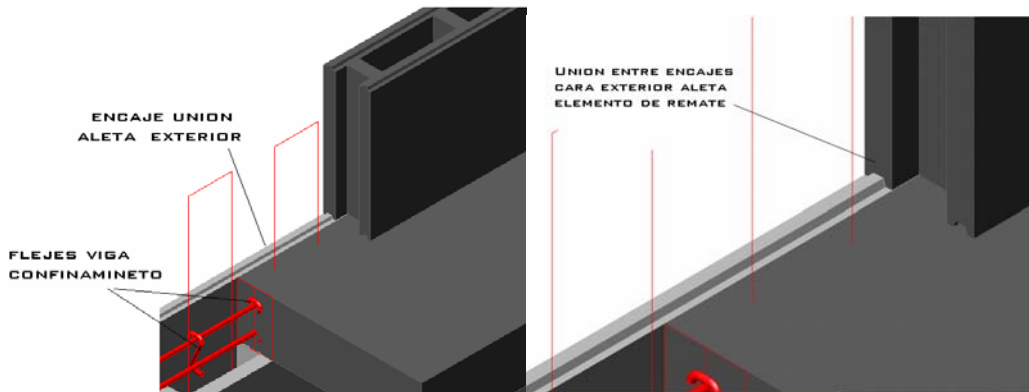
EMPALME DEL ENCAJE EXTERIOR UNIÓN MURO PRIMER PISO CON MURO SEGUNDO PISO.
